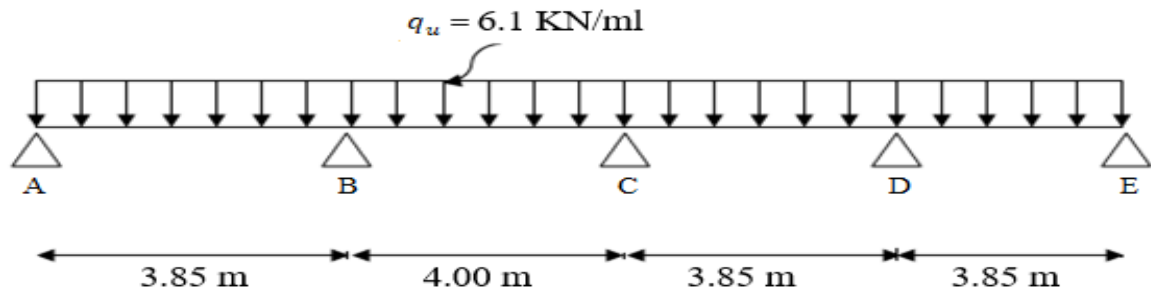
schéma statique de la poutrelle à l'ELU.
